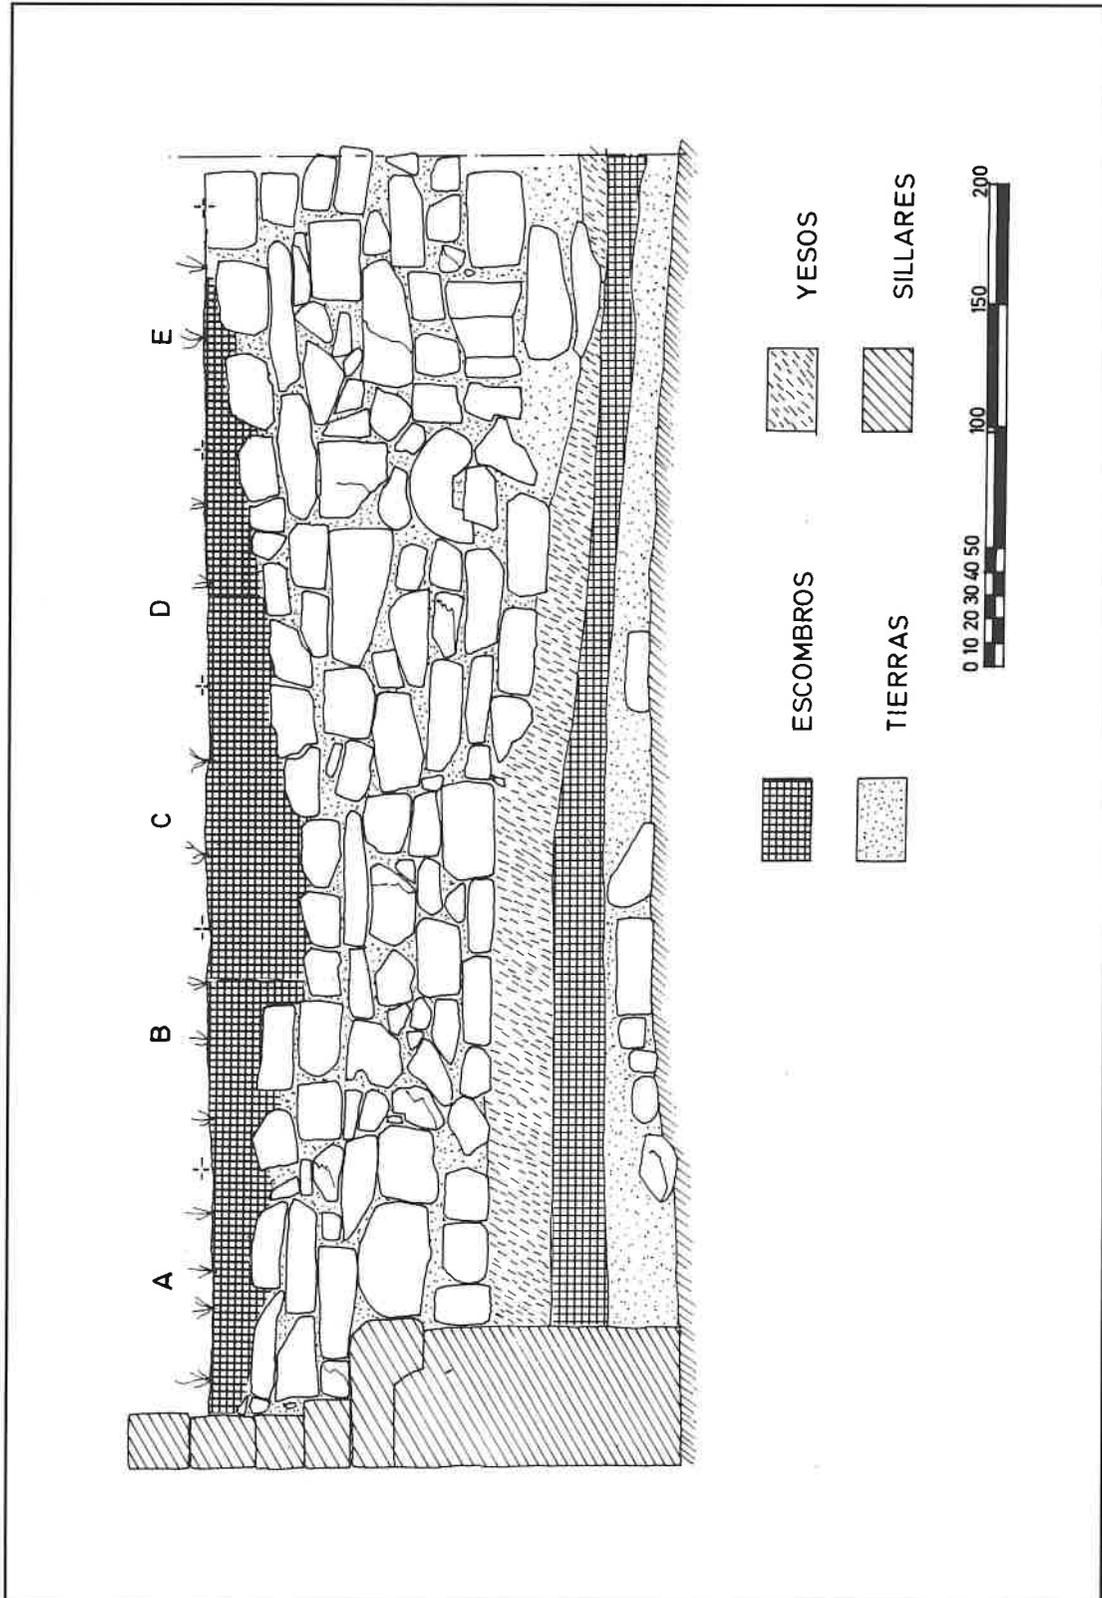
Alzado norte del muro situado en el interior de la sala 2 y sección estratigráfica.
